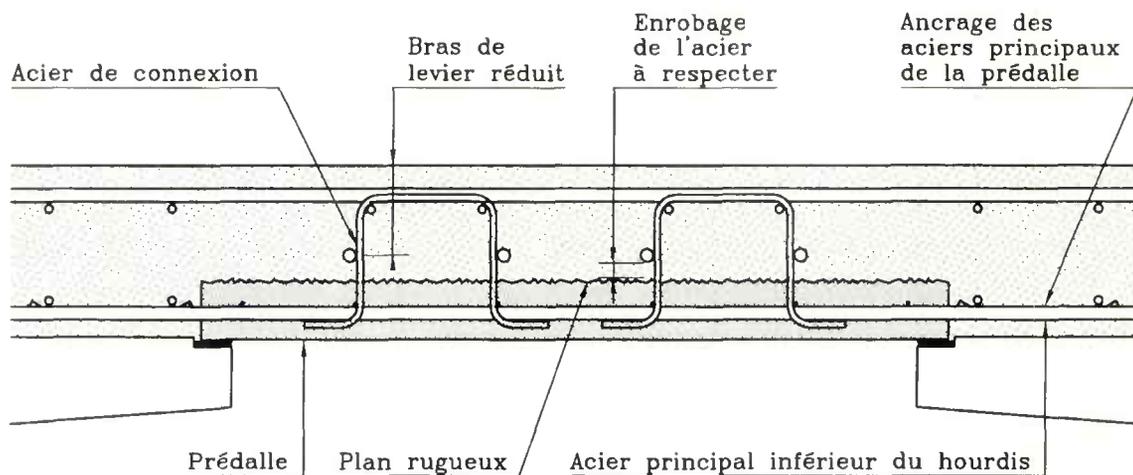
Exemple de ferrailage du hourdis sur prédalles participantes.
